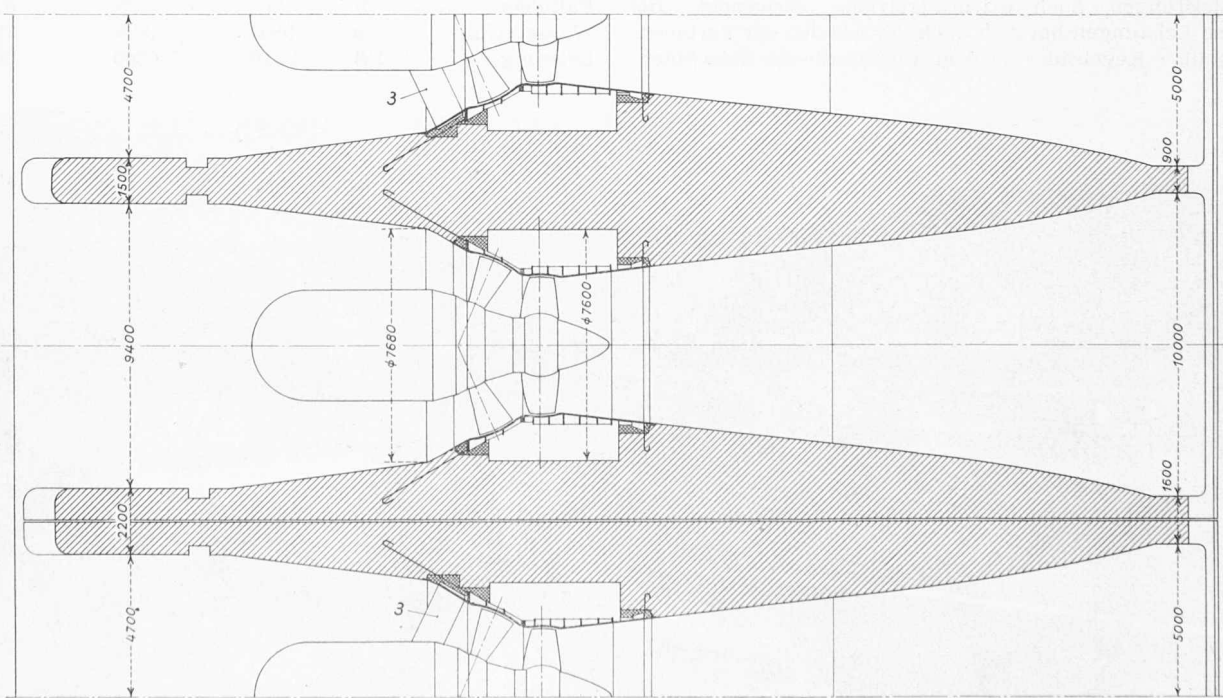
Horizontalschnitt auf der Höhe der Turbinenachse der Anlage Neef mit fast gleichen Abmessungen des Turbineneinbaues wie bei der Anlage Trier, 1:250
